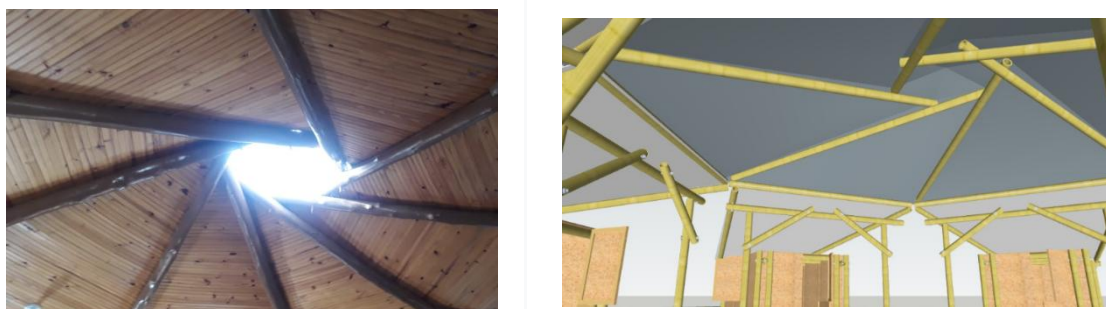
Contraventamento cobertura. Fonte: Autores (2023).
